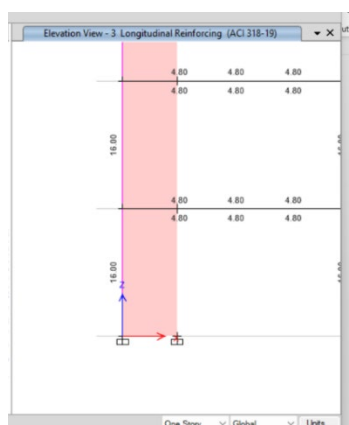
Área requerida para colocar acero en la columna (ETABS)
